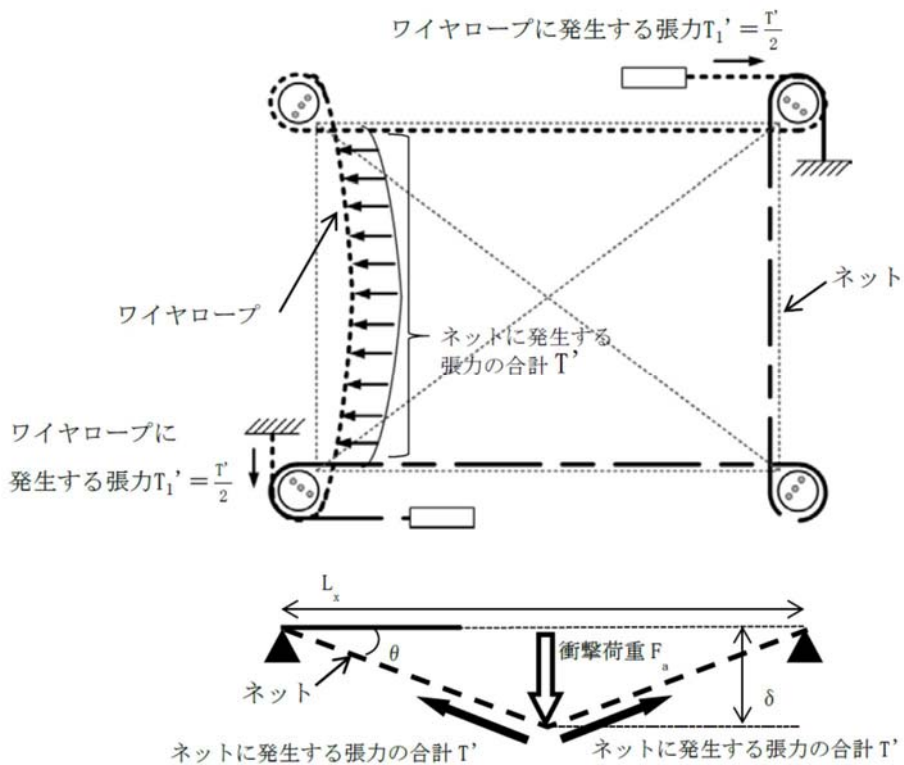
ネット及びワイヤロープに発生する力のつり合い(ネット平面図及び断面図)
